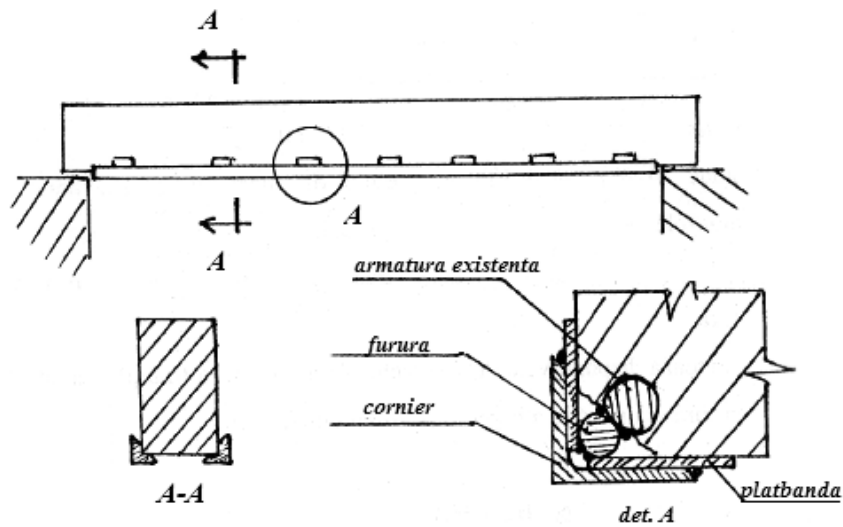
Consolidarea grinzilor din beton armat cu corniere metalice [66]
